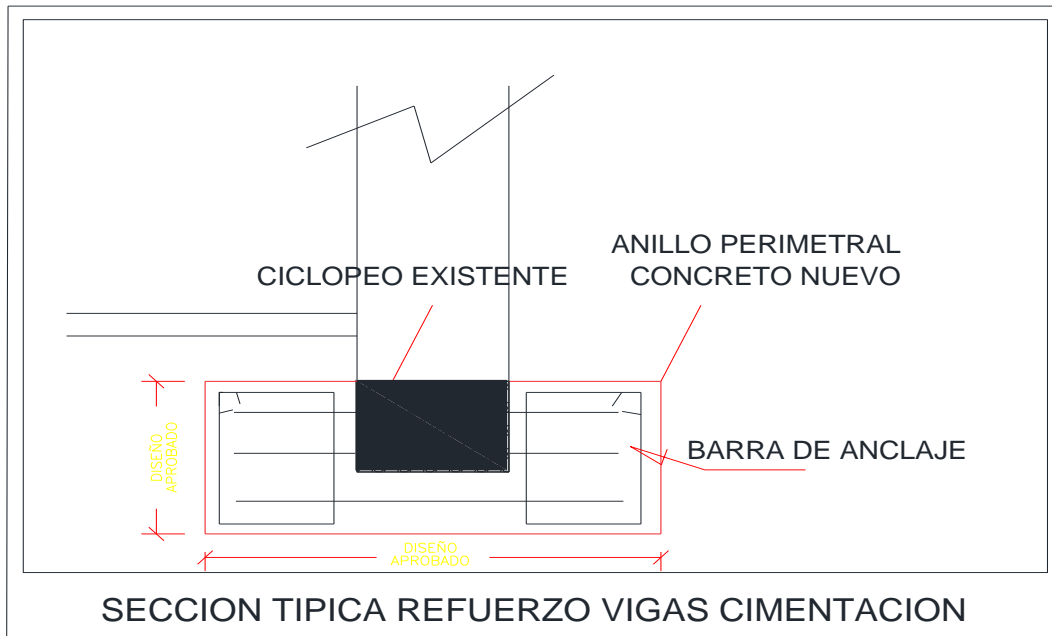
Sección típica refuerzo de cimentación (Fuente. Los Autores)
